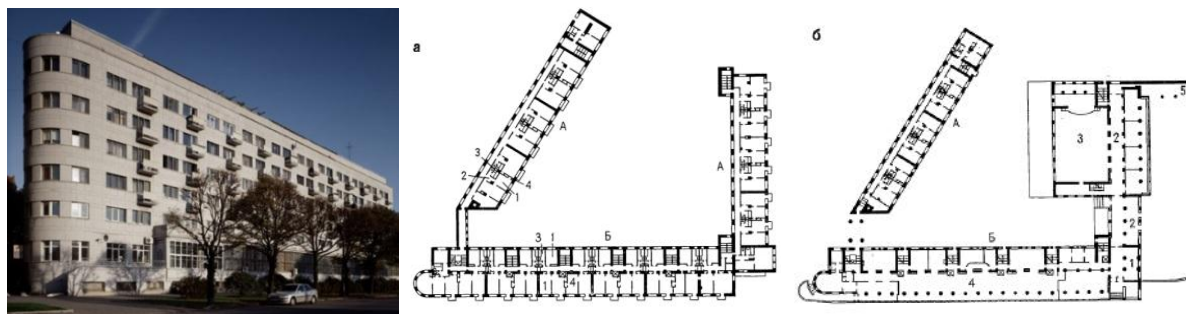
Жилой дом общества политкаторжан на Петроградской набережной. 1931-1933 гг. арх. Г. Симонов. Общий вид, план типового этажа; план 1-го этажа
